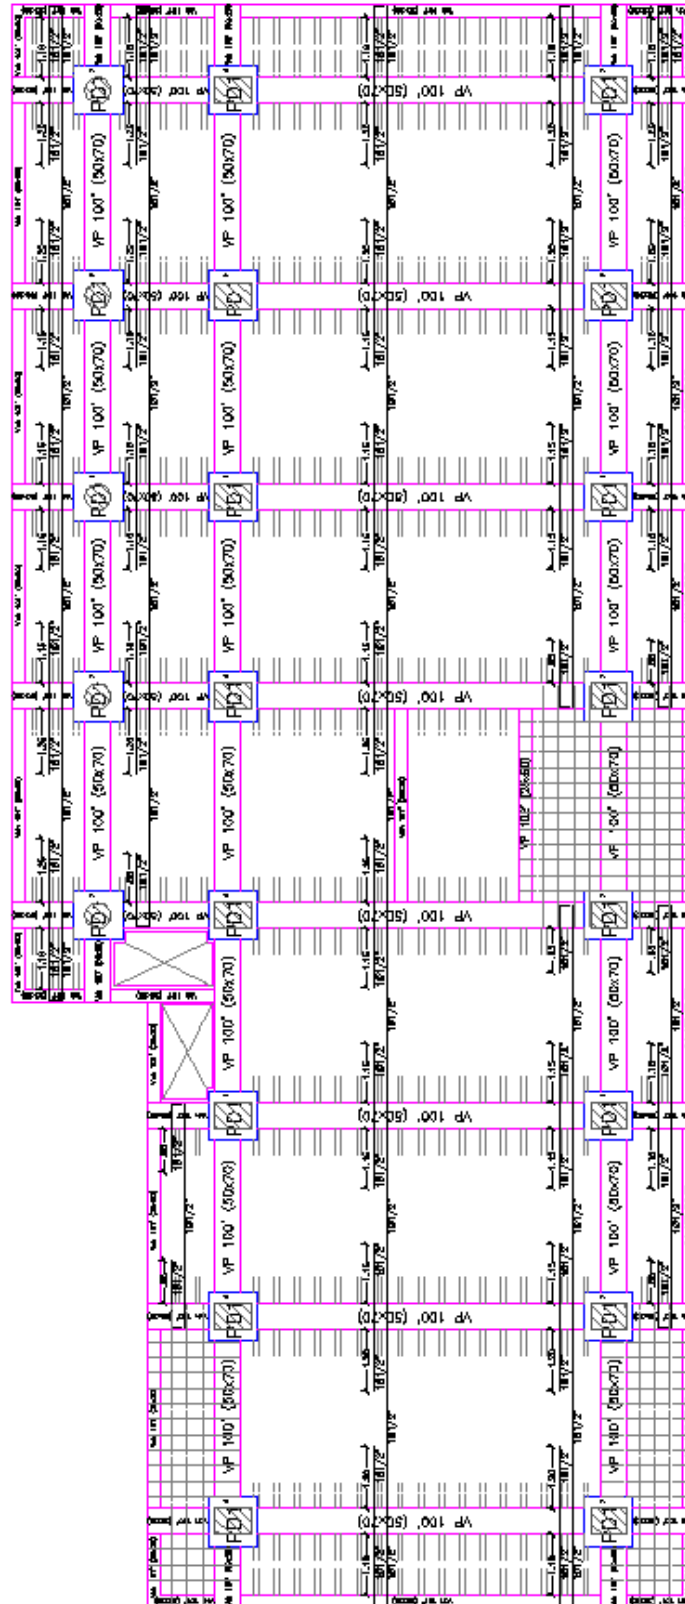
Planta, aligerado 1', NTNT: +0.40.
